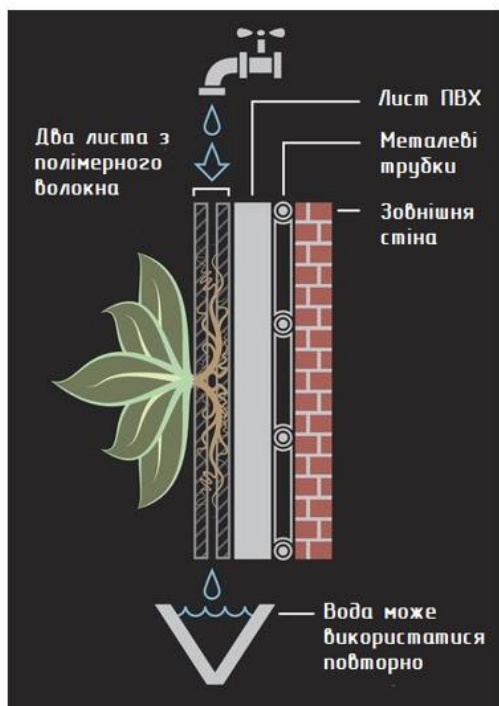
Схематичне зображення конструкції озеленення фасаду
